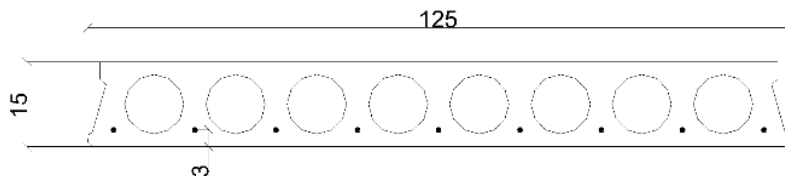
Seção Laje Alveolar H20. (PUMA LAJES ALVEOLARES, 2020)
